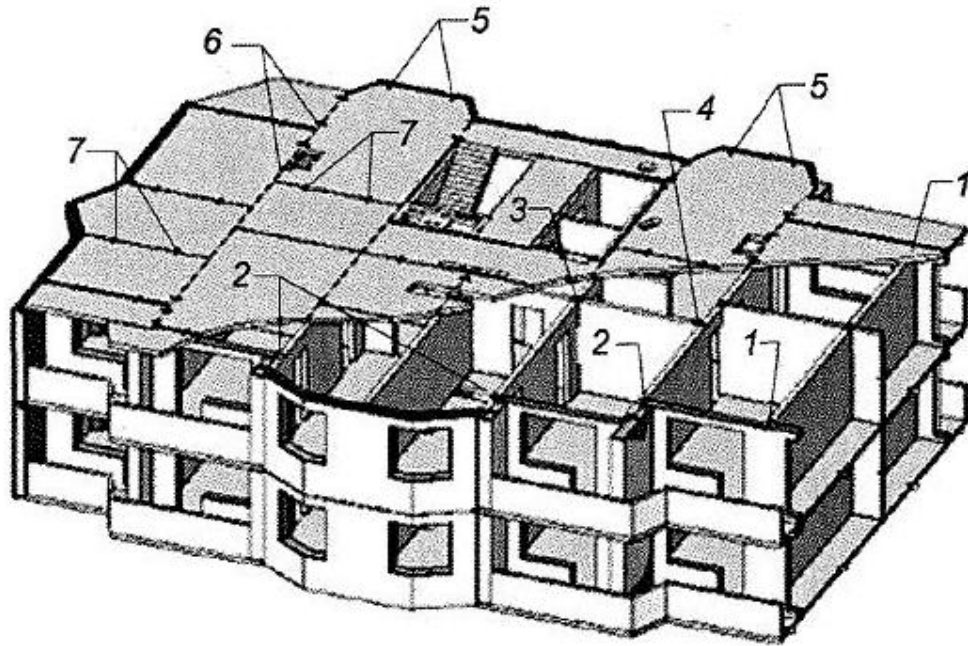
1 - связь между панелями наружных и внутренних стен; 2 - связь между продольными наружными несущими стенами; 3 - связь между продольными внутренними стенами; 4 - связь между поперечными и продольными внутренними стенами; 5 - связь между наружными стенами и плитами перекрытий; 6 - связь между плитами перекрытий вдоль длины здания; 7 - связь между плитами перекрытий поперек длины здания.
